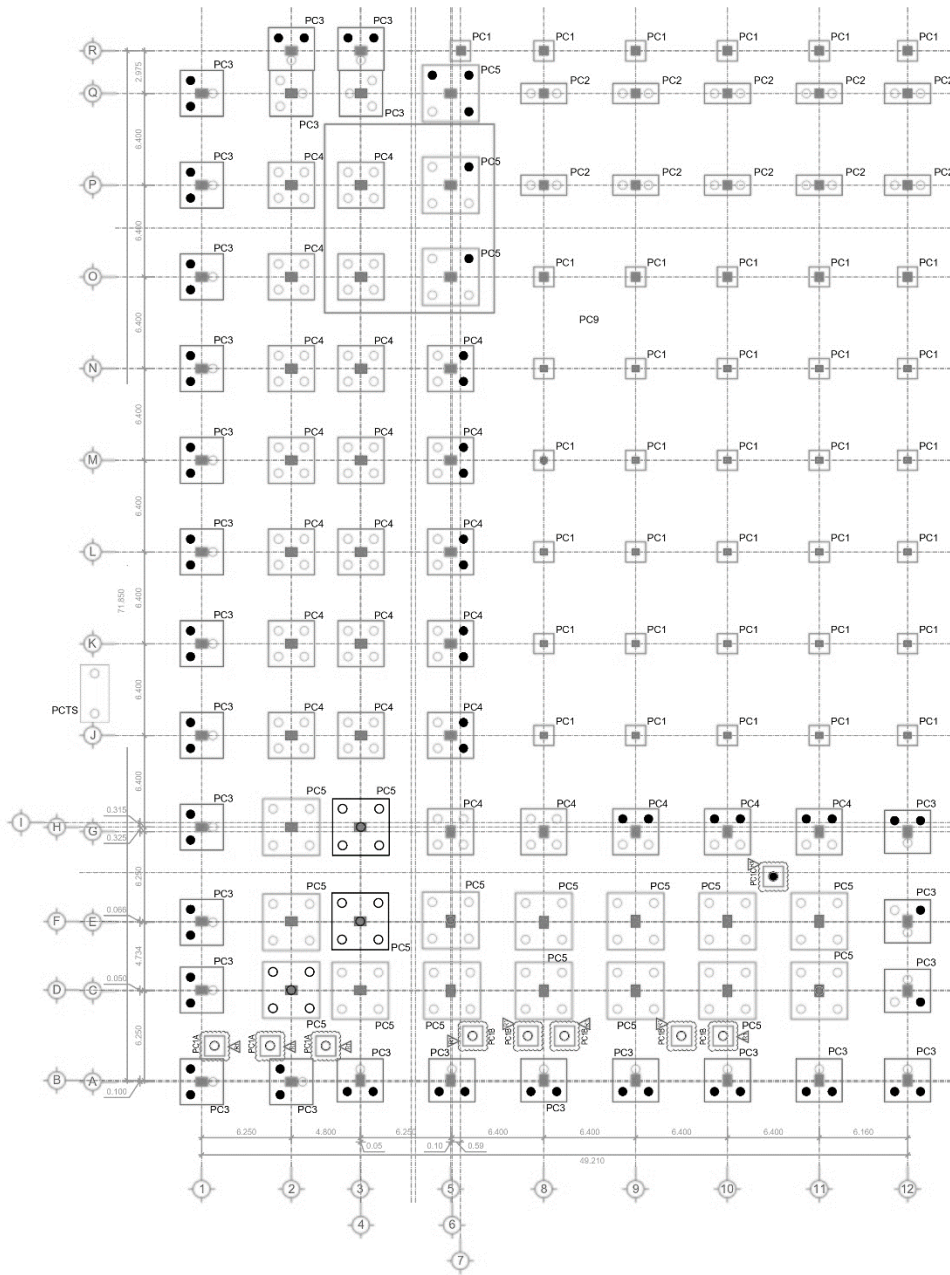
3 Peta Pekerjaan Kolom lantai.1
